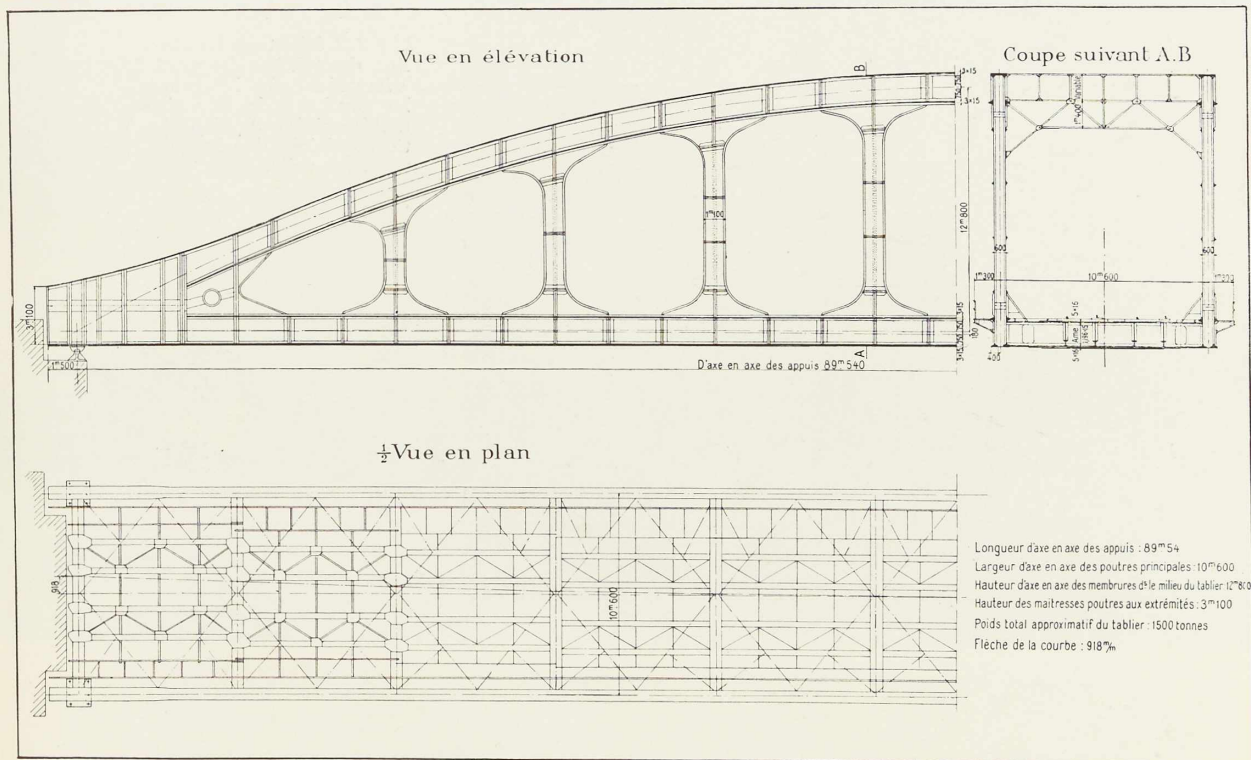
Vue en élévation, en plan et en coupe du pont de Malines.
